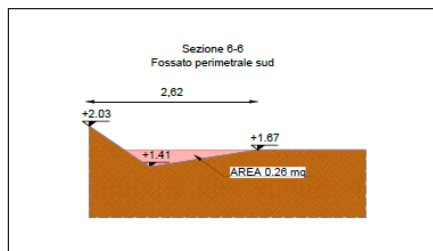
Sezioni fossato esistente a sud con indicazione area utile.
